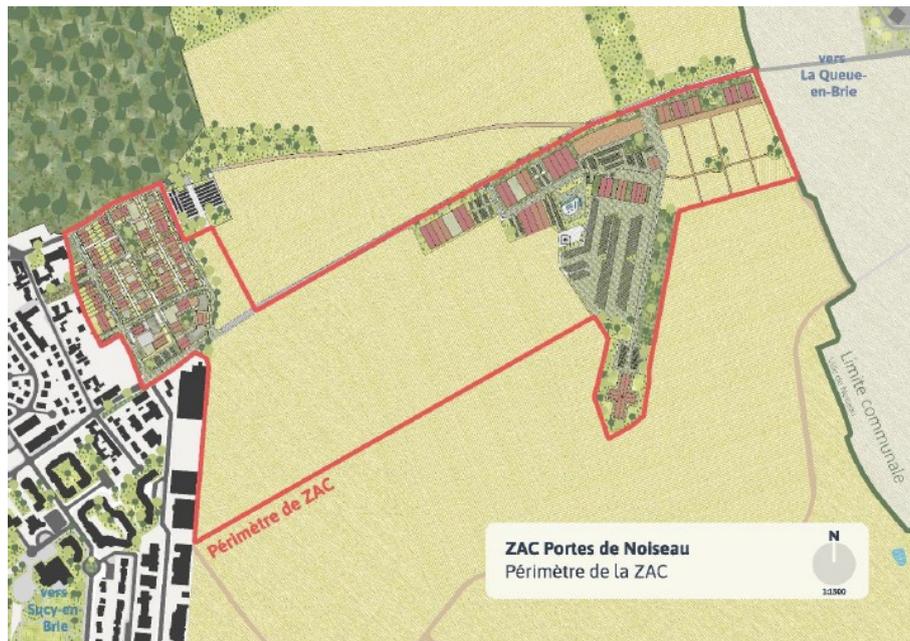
Périmètre et plan d'aménagement du projet de Zac des Portes de Noiseau (Étude d'impact p. 1)
